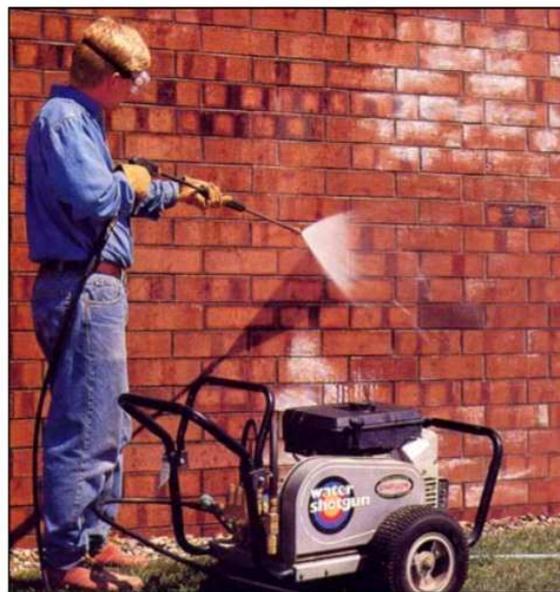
Lavado de grietas (Black & Decker 2000).
